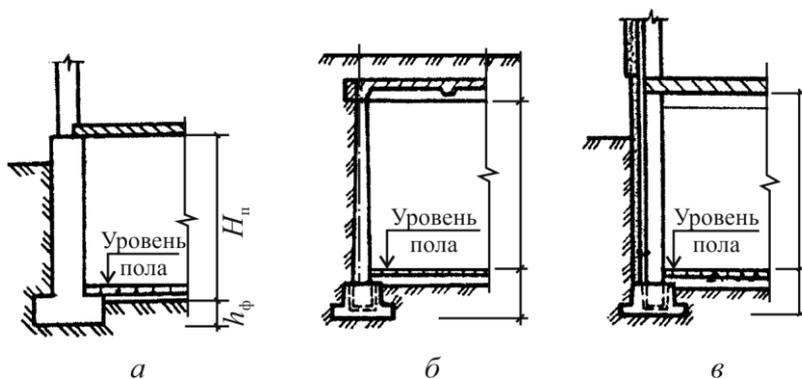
Типы наружных стен подвала: *а* – массивная стена; *б* – гибкая стена, опертая на перекрытие; *в* – гибкая стена, опертая на колонну
